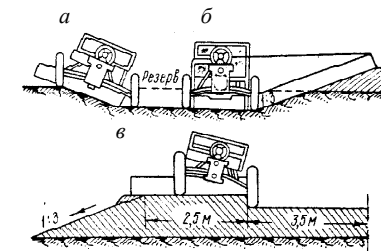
Положение ножа автогрейдера при планировке: а – внешнего откоса резерва; б – внутреннего откоса резерва; в – обочины
